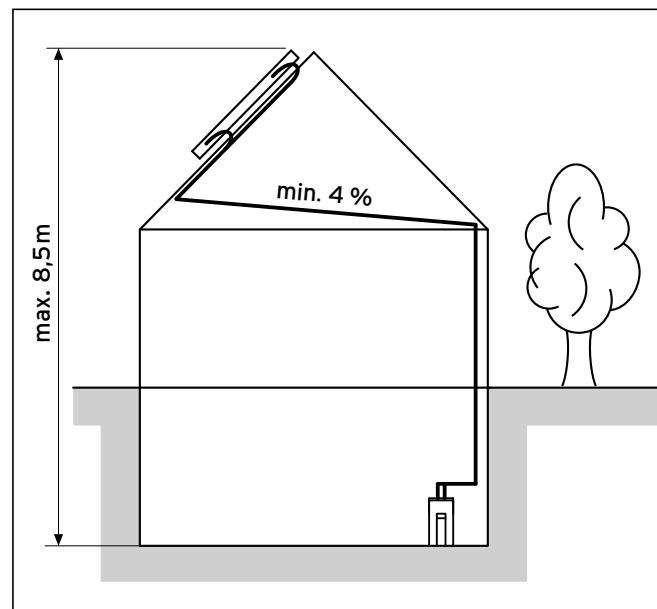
Hauteur de l'installation et pente des conduites sans "réceptacle de retour solaire"
